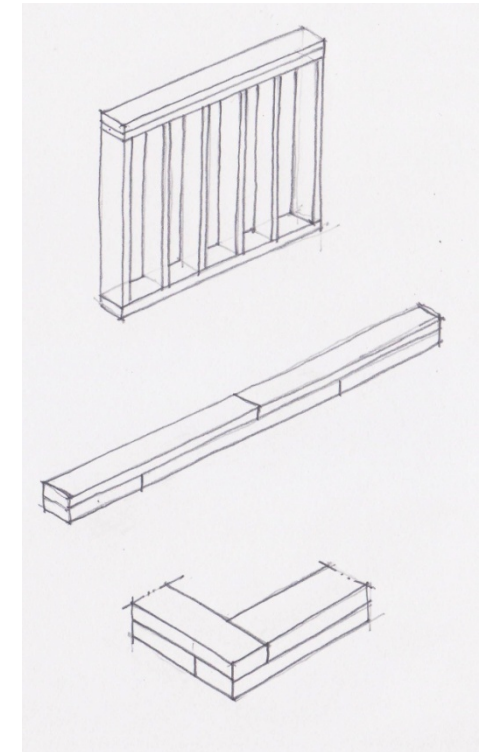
Parede de prumos, sobreposição da travessa de tecto e encontro da travessa no cunhal. (des. autor)
